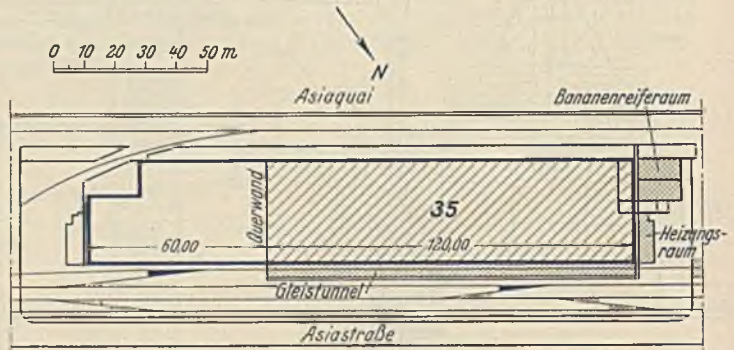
Grundriß des umgebauten Kaischuppens 35.
